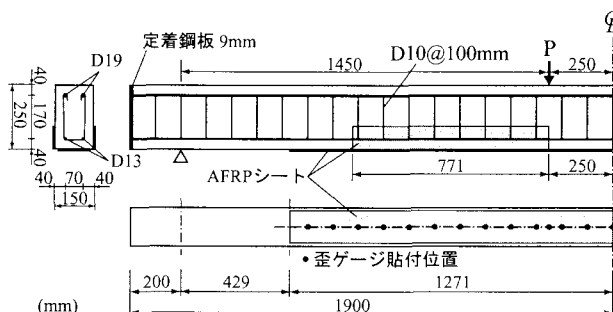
試験体の形状寸法、配筋状況、載荷点位置およびシート補強概要図の一例 (S90 試験体)
